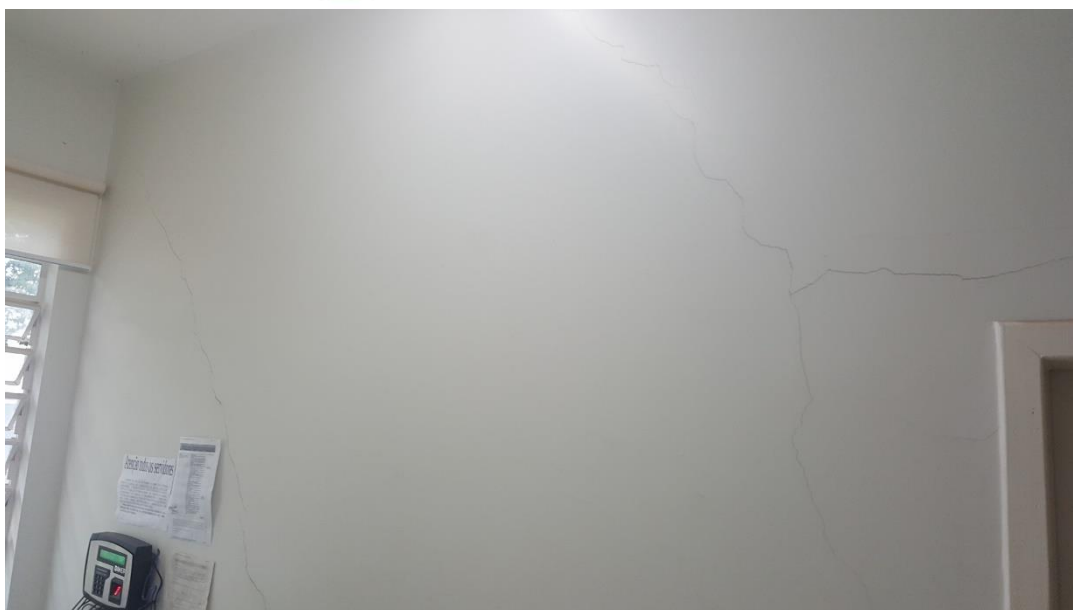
Vista da parede de divisa entre corredor e sala 53 (coordenação), destacando fissuras em paredes. Foto datada em 29/11/2016.
